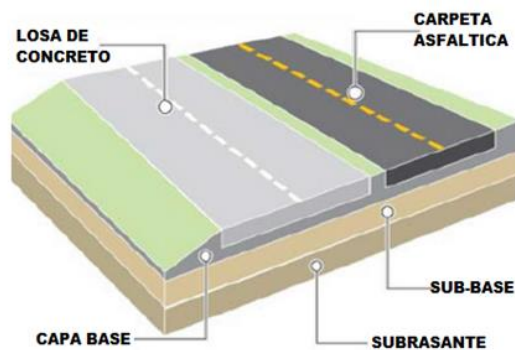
Estructura del pavimento asfáltico o flexible y de concreto o rígido
